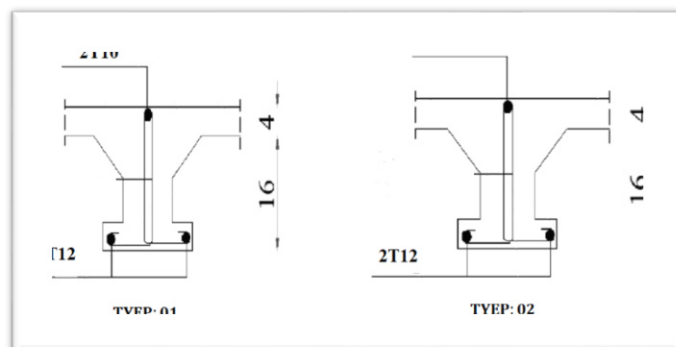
schéma ferrailage de plancher Pour étage courant
